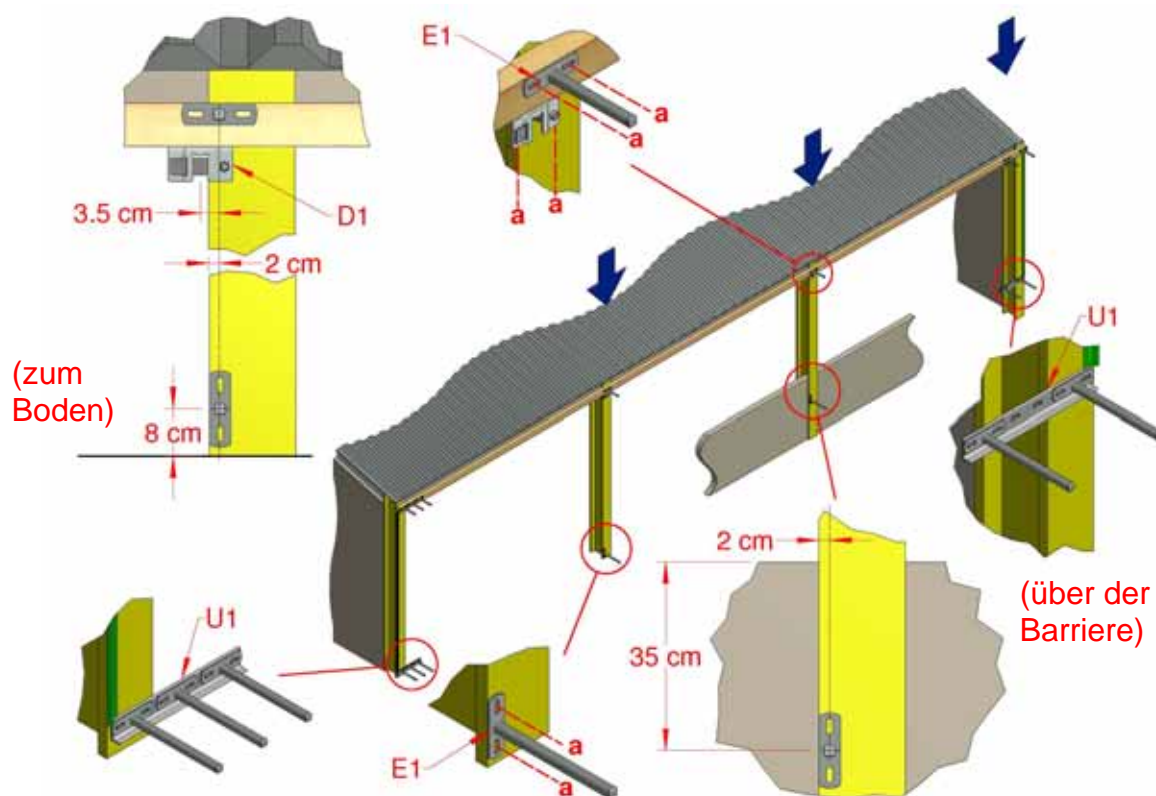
Montage der Halterung für die mittleren Führungsrohre (stirn-/stirnseitige Ausführung)
